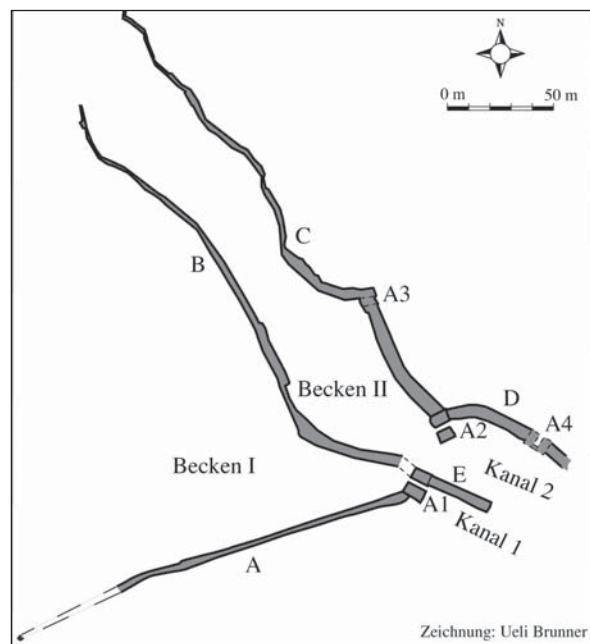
Grundriss von Mabnā al-Ḥašrağ (nach: DAI 2004, 1)
